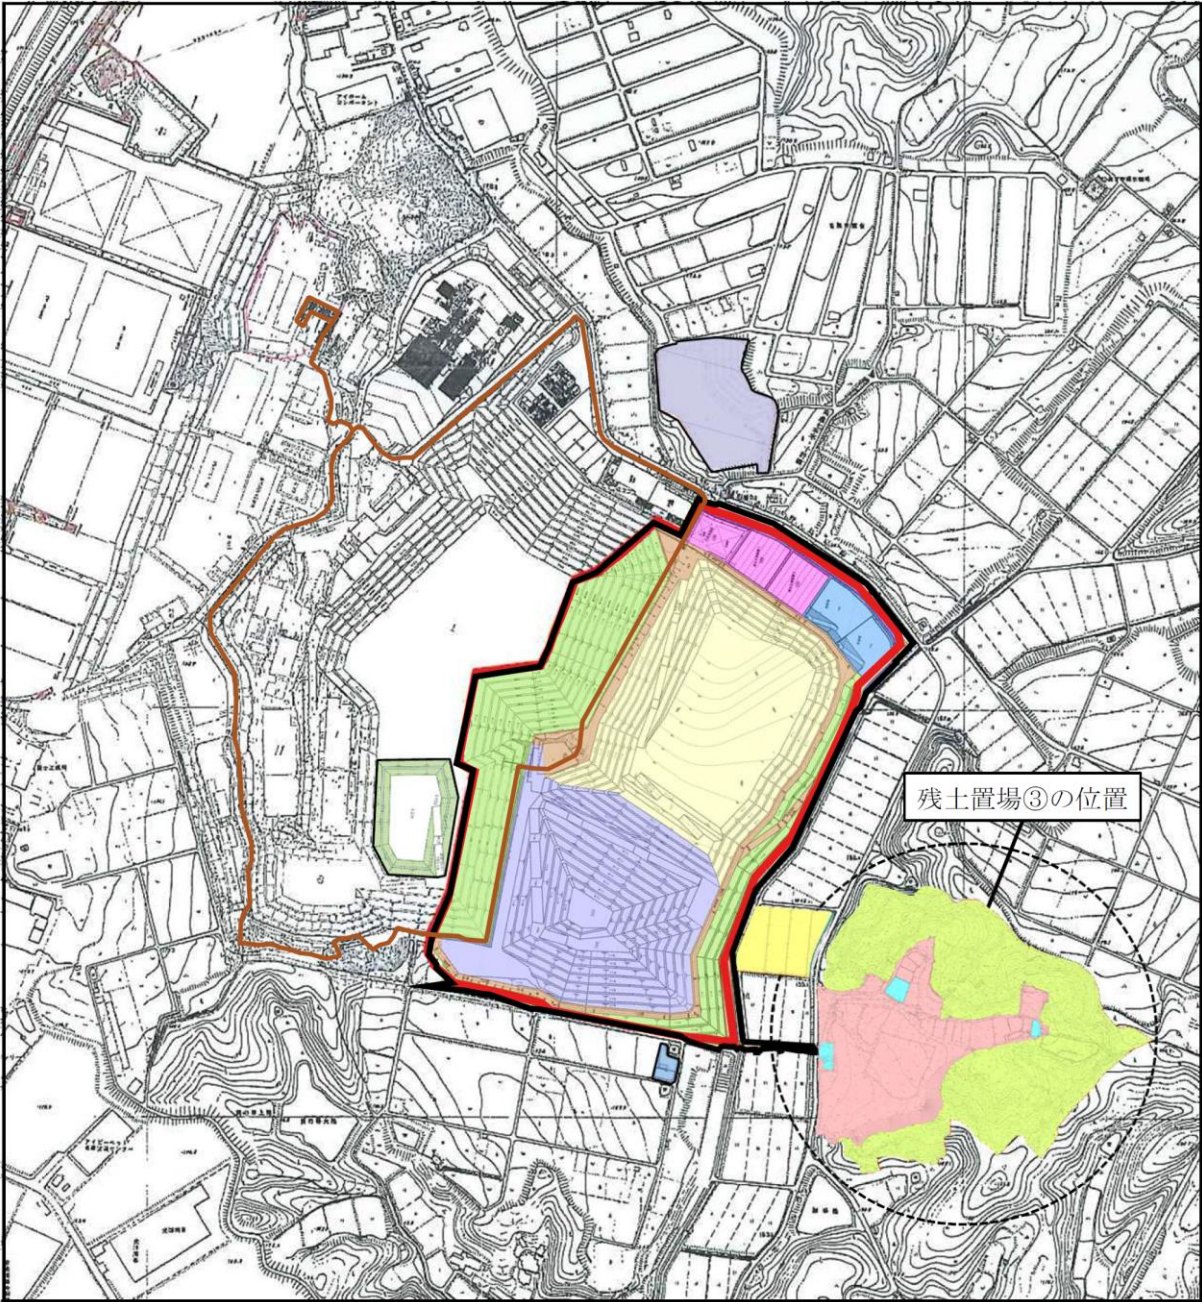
(1) 土地利用計画平面図(第1期工事:埋立前) <変更前>
